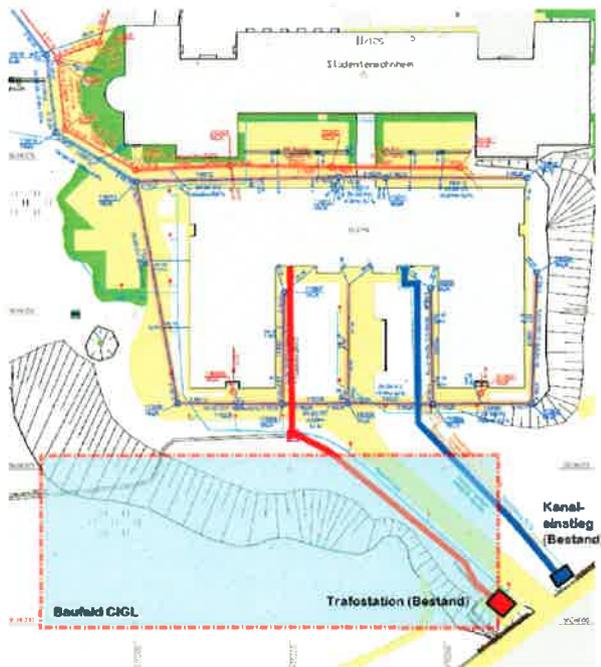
Infrastruktur – Umverlegung bestehende Erschließung ECCPS
